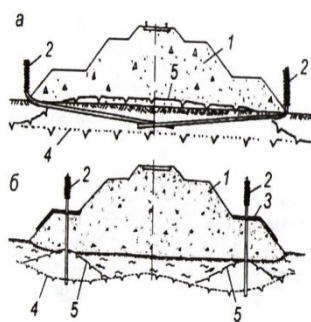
Использование термосифонов для охлаждения основания земляного полотна: а – наклонные и б – вертикальные термосифоны. 1 – земляное полотно; 2 – термосифон; 3 – теплоизоляция; 4 – верхняя граница криолитозоны до и 5 – после устройства земляного полотна
